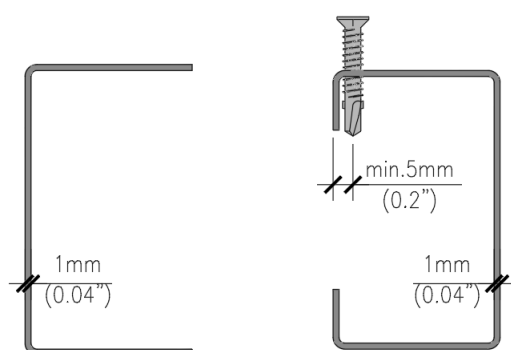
Secção tipo de estrutura em aço galvanizado
